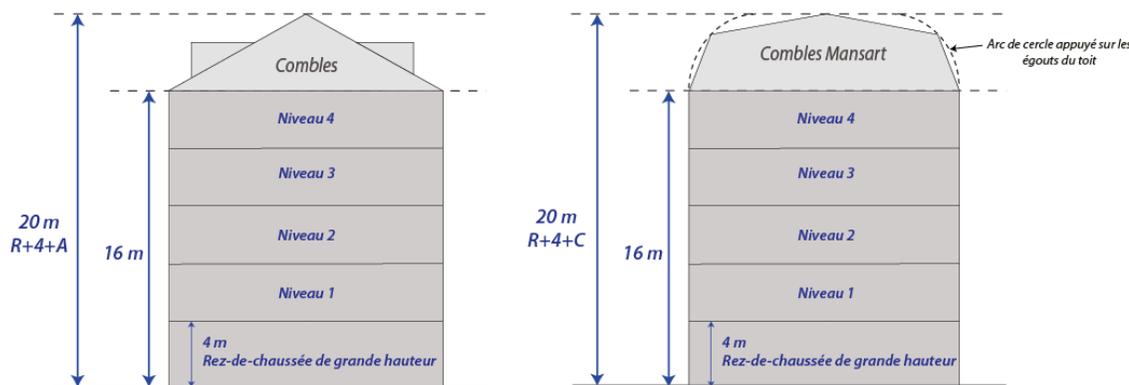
Rez.de.chaussée + 4 niveaux + Combles (R+4+C)
